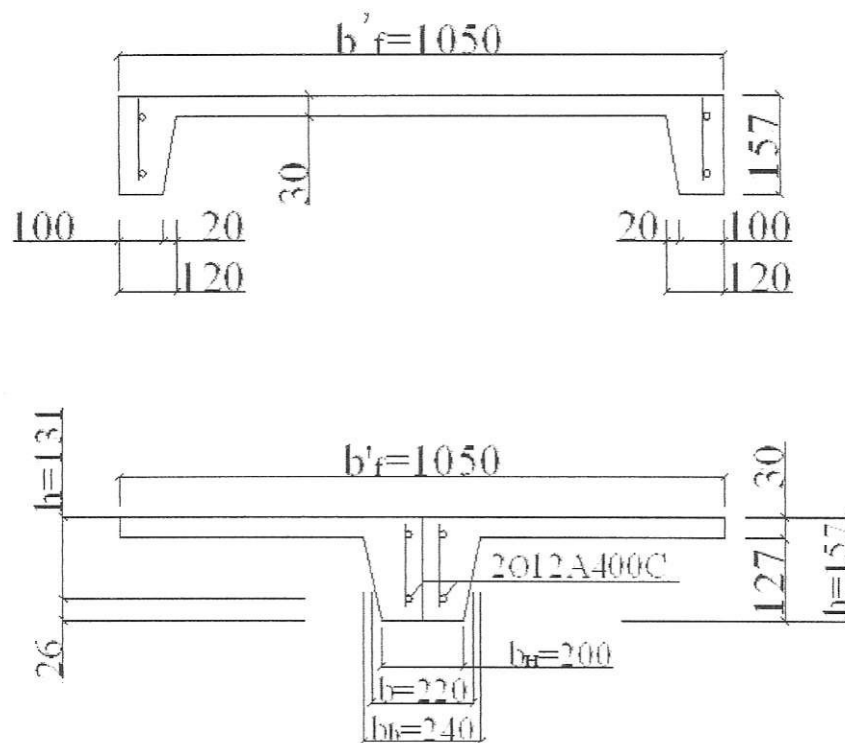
Поперечний переріз ребер сходового маршу.
